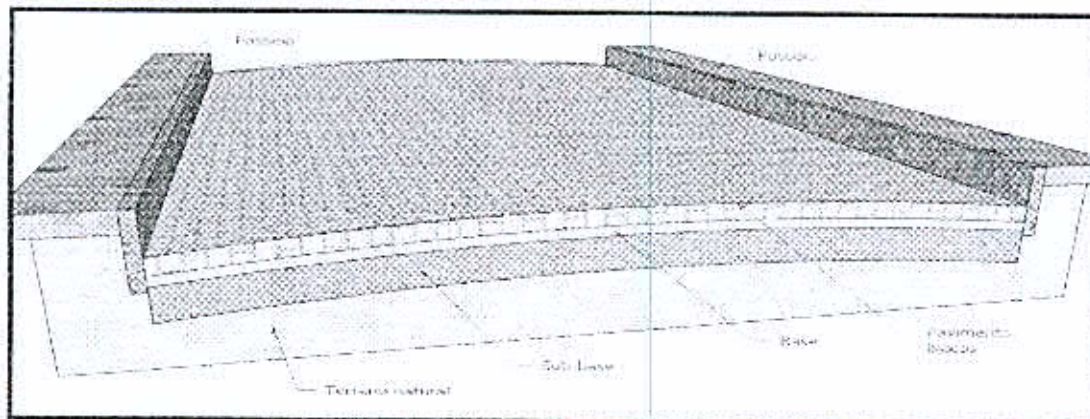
Desenho esquemático do perfil transversal da pavimentação
